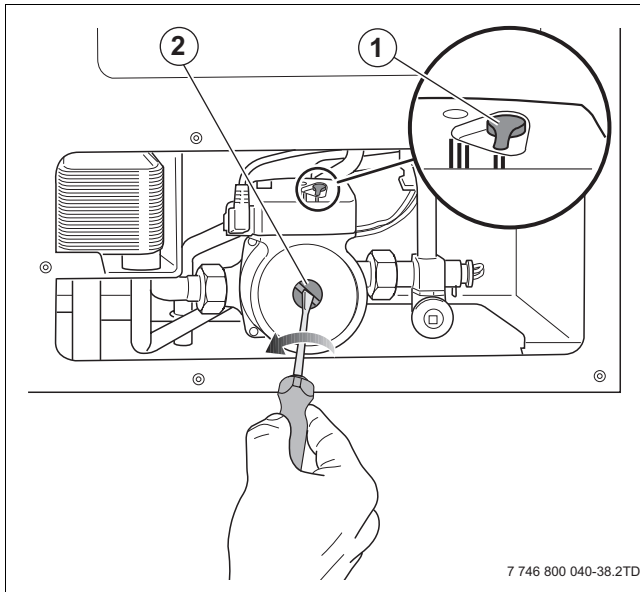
Удаление воздуха из загрузочного насоса бака-водонагревателя
